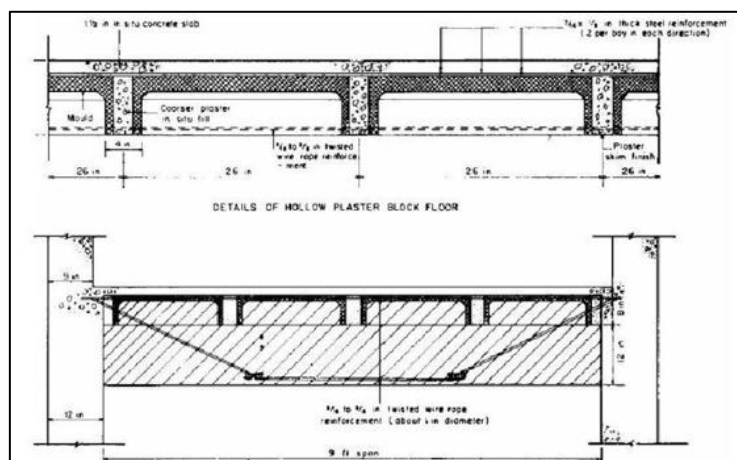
Laje com nervura aparente e laje com preenchimento dos vazios.
